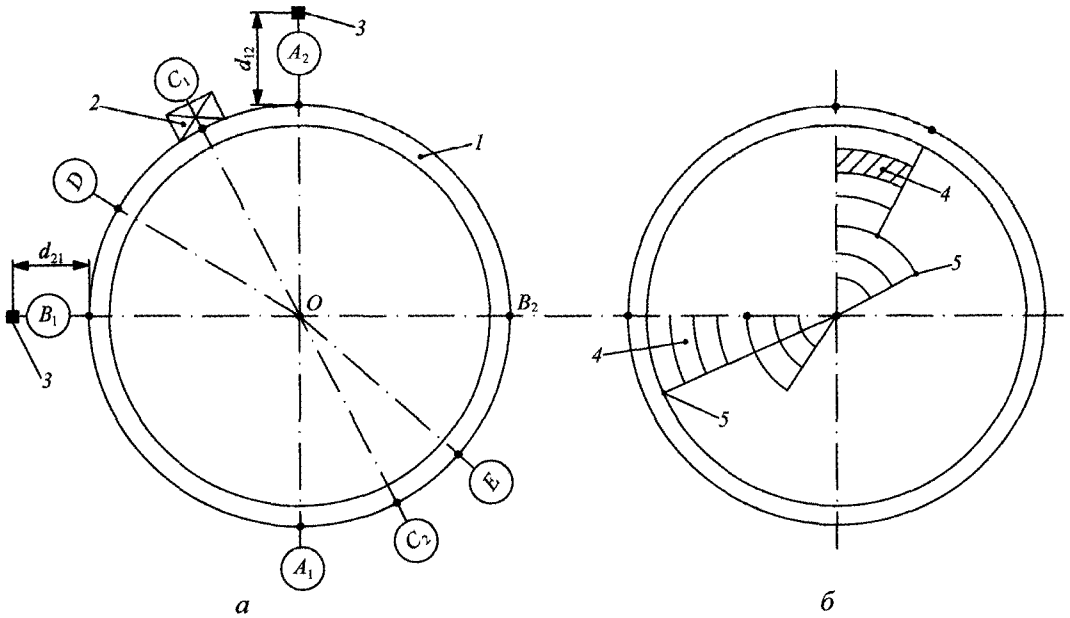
Розмічування осей і контроль укладання основи циліндричного резервуара:
